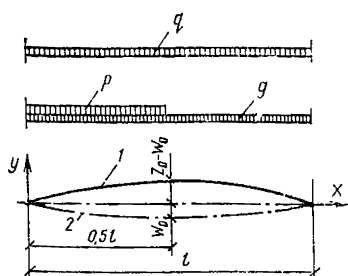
Расчетная схема панели-оболочки КЖС
